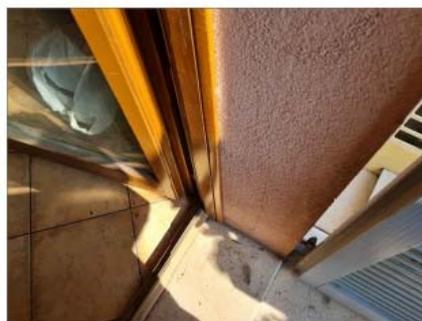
DETTAGLIO FINESTRA BALCONE
